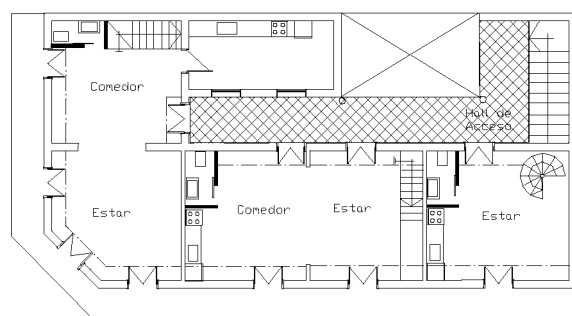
y 6: Alternativa de diseño tipo A propuesta para la vivienda de diagonal 74 entre 56 y 57
